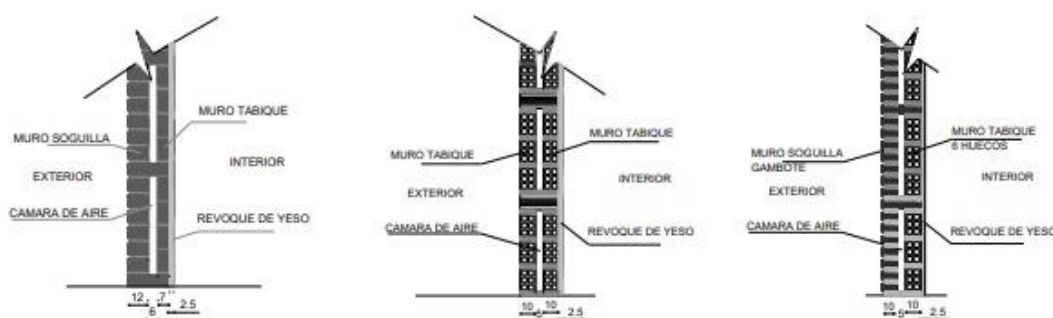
Muros exteriores con aislamiento térmico para paredes lado S, SE, SO
